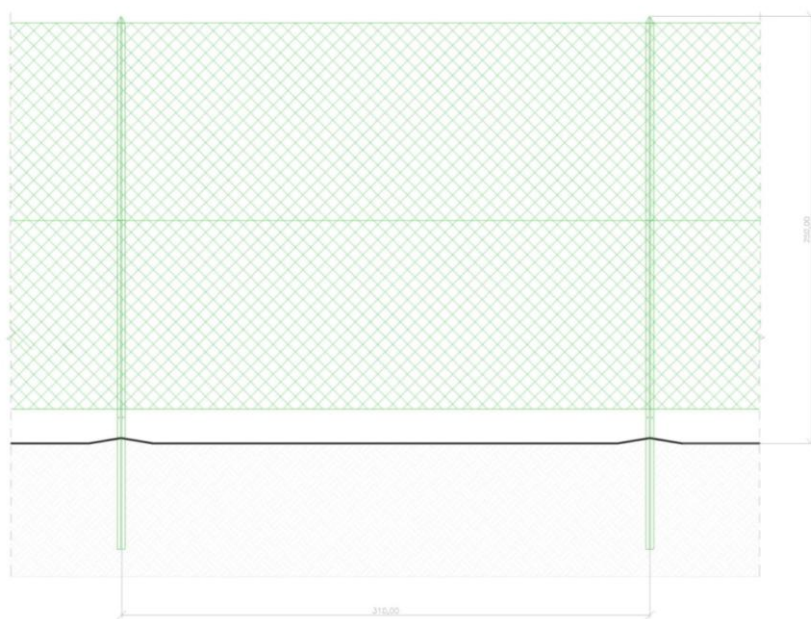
Prospetto tipo recinzione perimetrale con apertura inferiore (20-30 cm) per il passaggio della piccola fauna.
